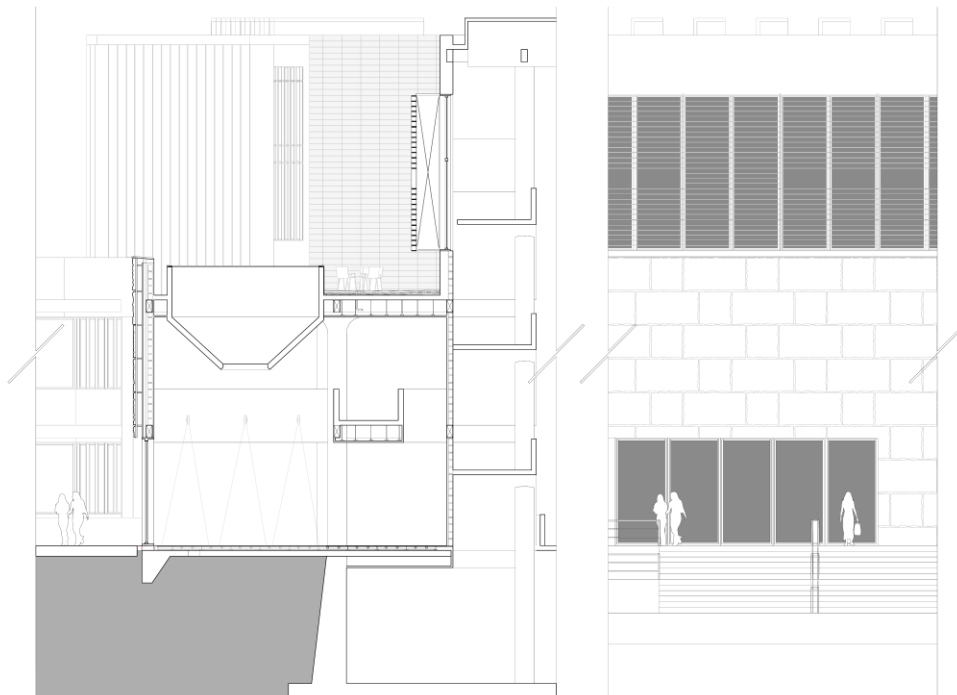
Corte Transversal Fugado del mercado. Elaboración Propia
